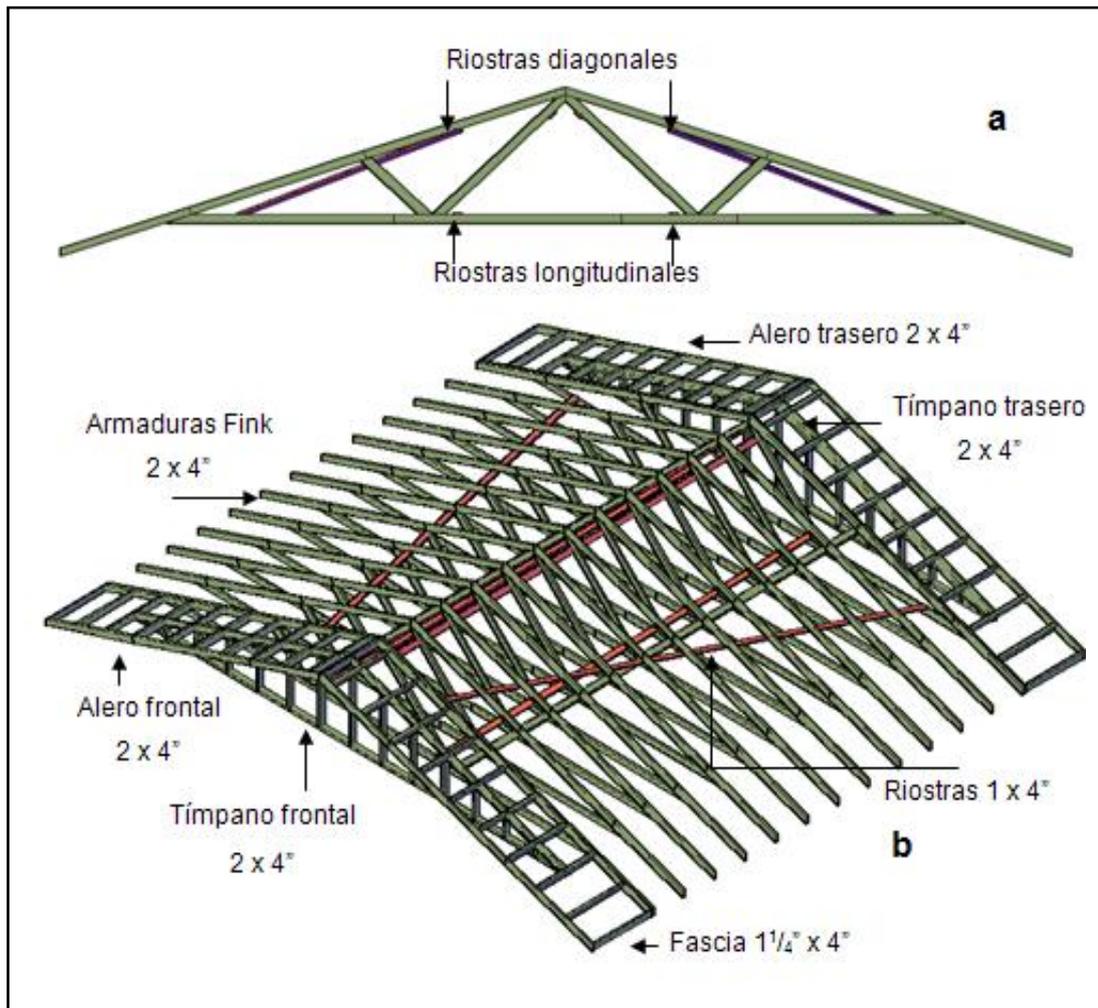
Ubicación de las riestras (diagonales y longitudinales) y dimensiones de las estructuras que componen el techo.
